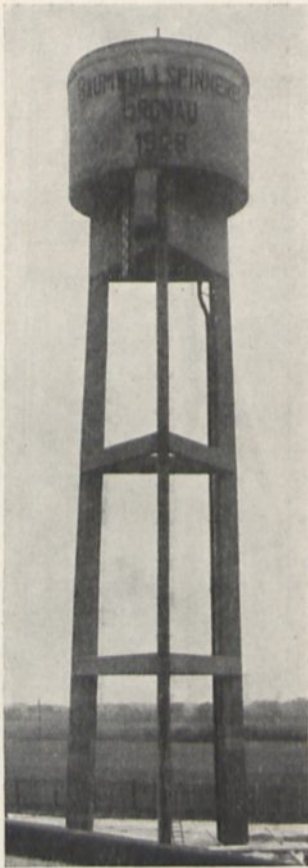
Wasserturm aus Eisenbeton. Schaubild.
